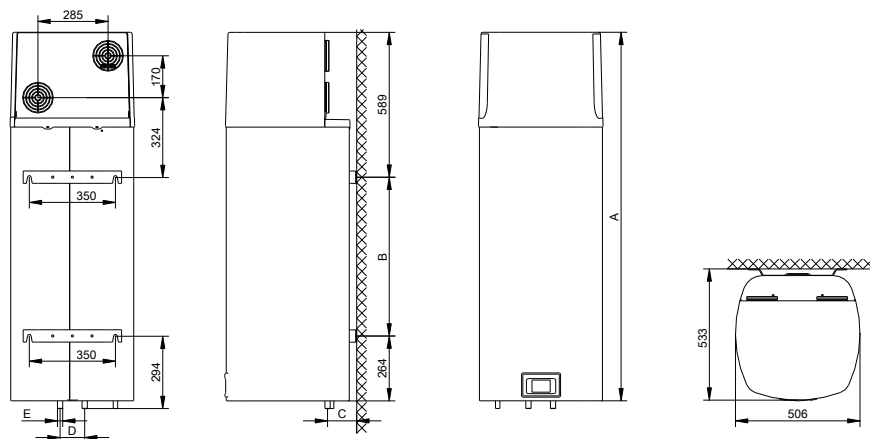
Dimensions de raccordement et de montage de la pompe à chaleur (mm)
